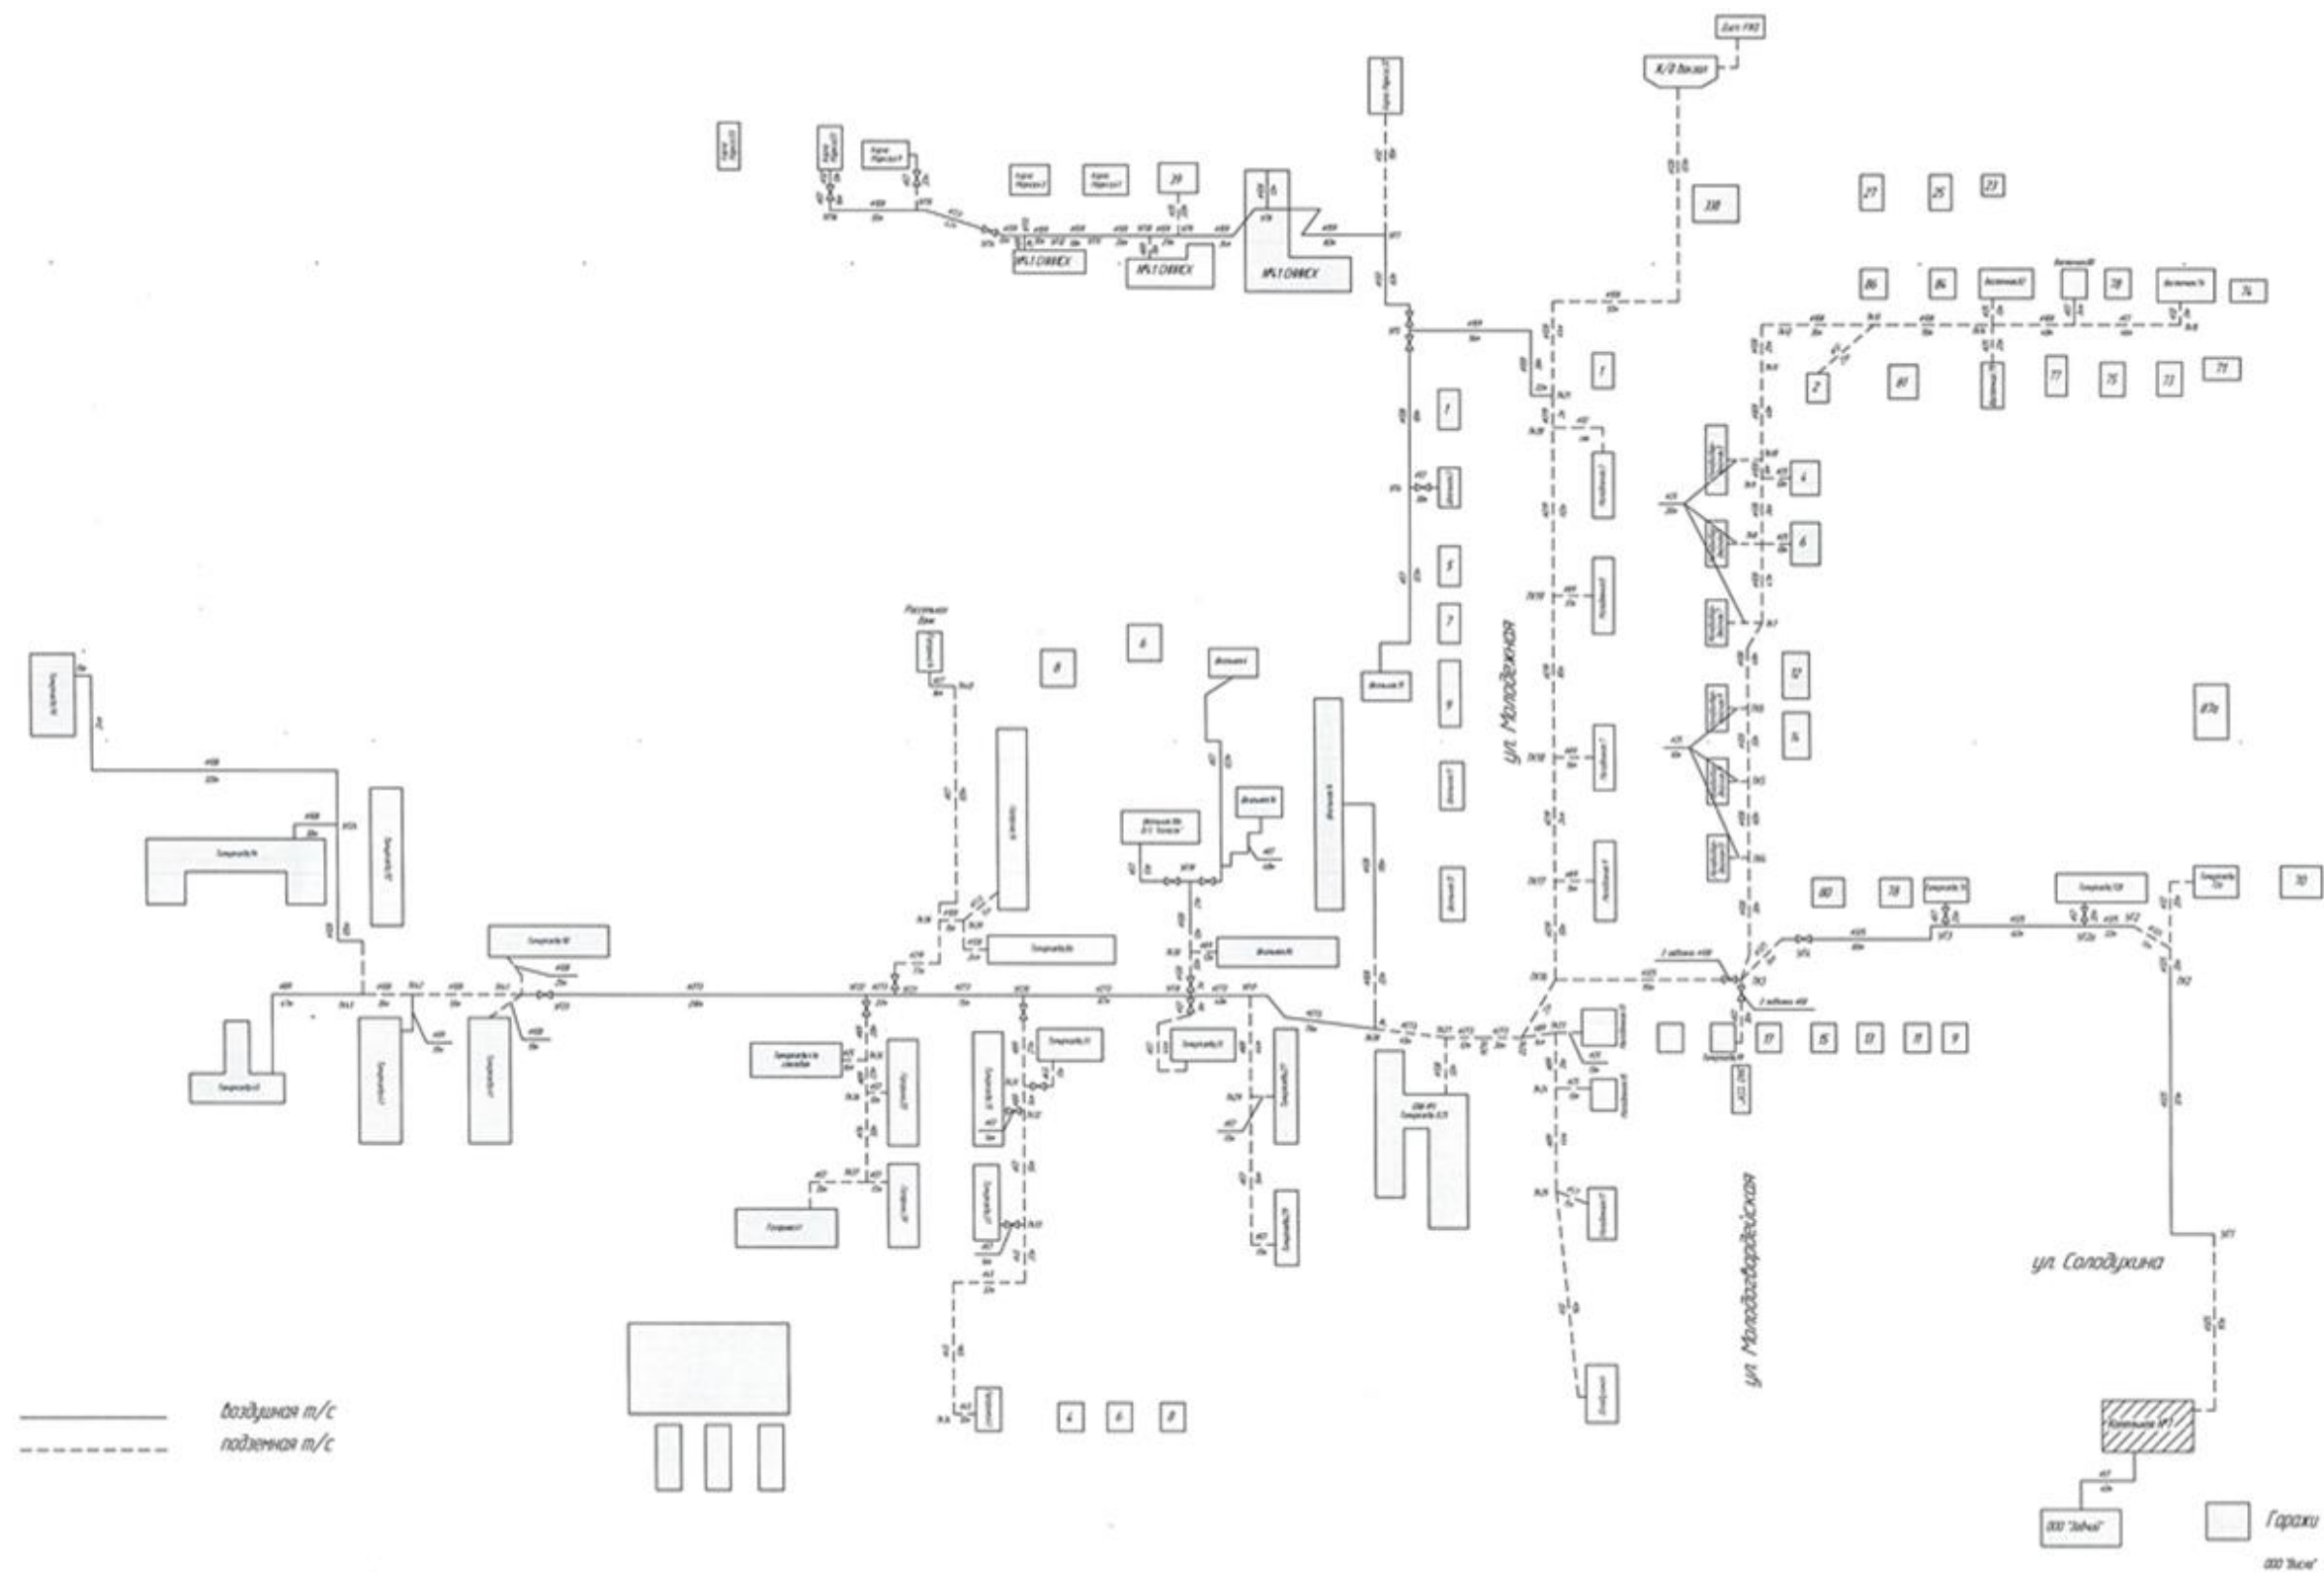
Схема тепловых сетей от здания котельной №7 п. г. т. Безенчук
